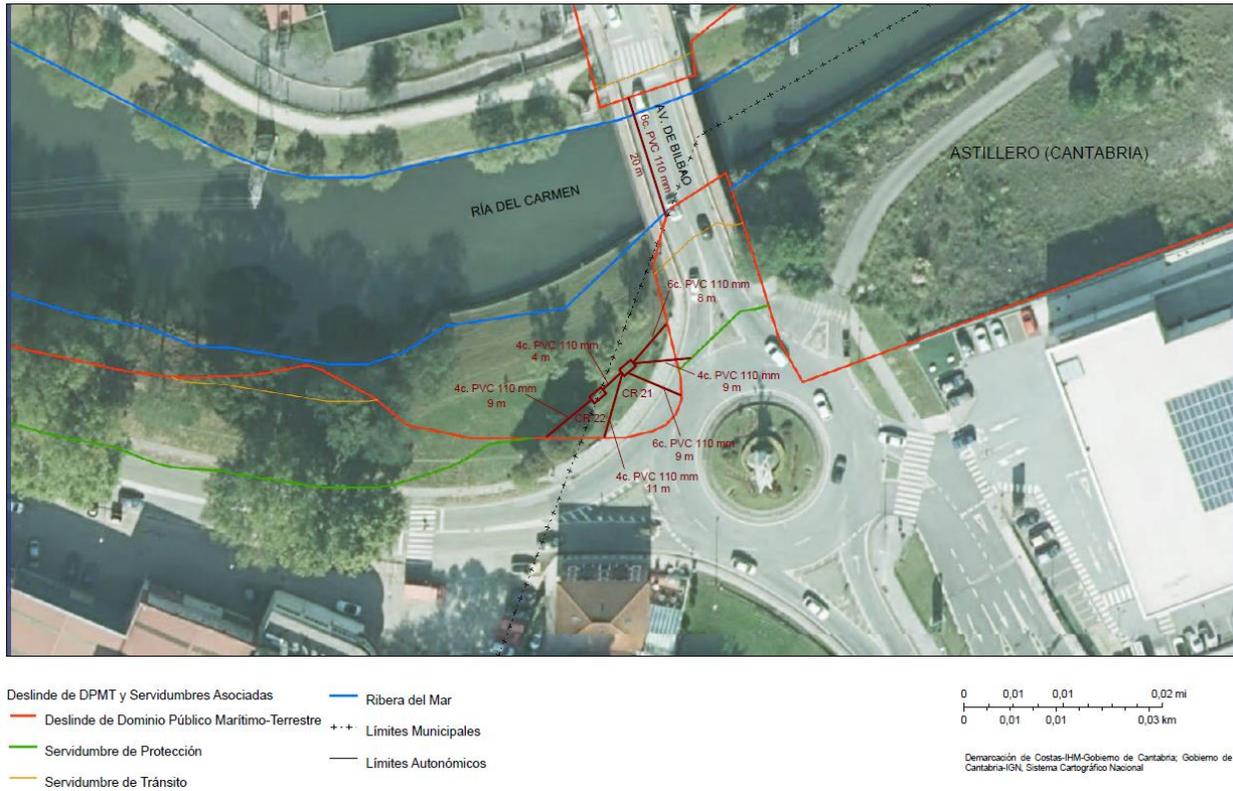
Detalle de la actuación objeto del proyecto (Fuente: Telefónica de España. Año 2022)
